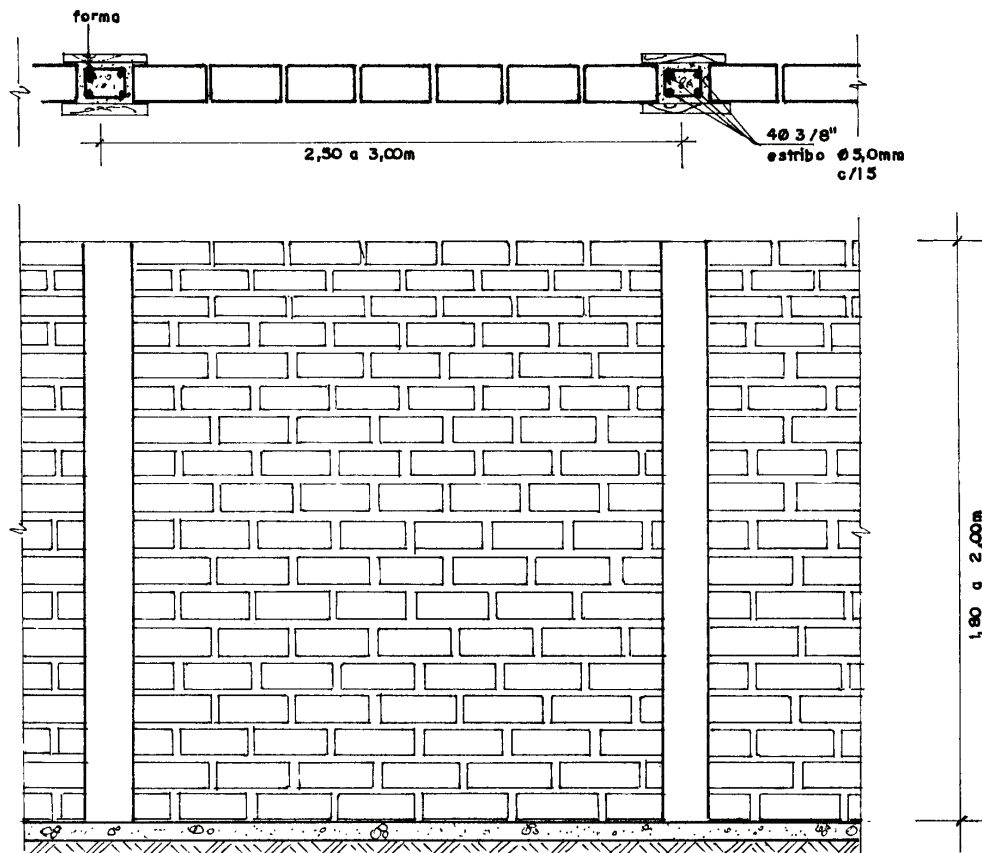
Detalhe de execução de um muro de tijolo maciço
